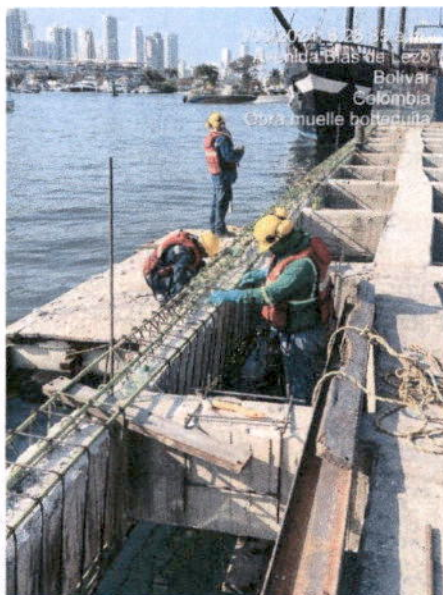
Avance de refuerzo de viga longitudinal 4..
